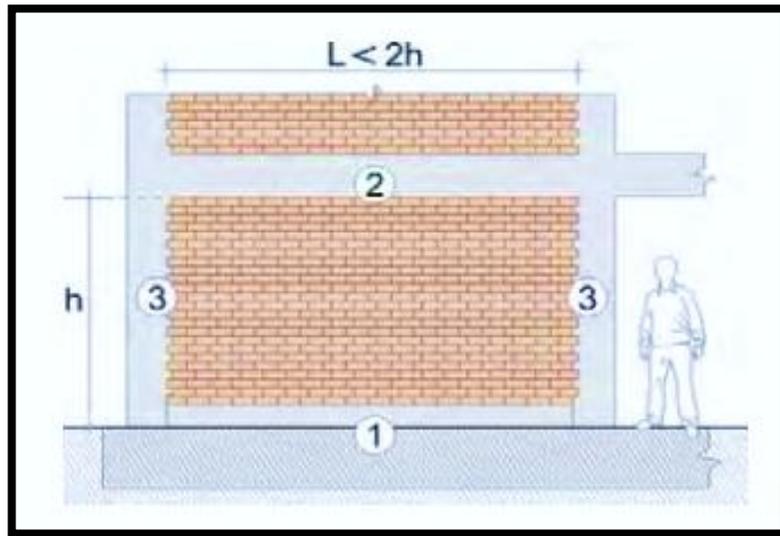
Albañilería Confinada (Fuente: Manual de reparaciones y reforzamientos de viviendas de albañilería confinada, 2008)
